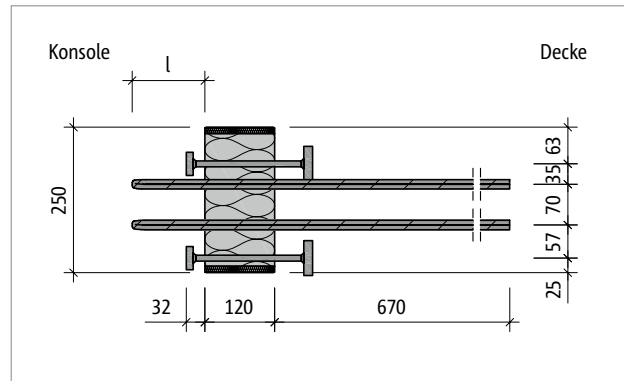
Schöck Isokorb® XT Typ O: Produktgrundriss
